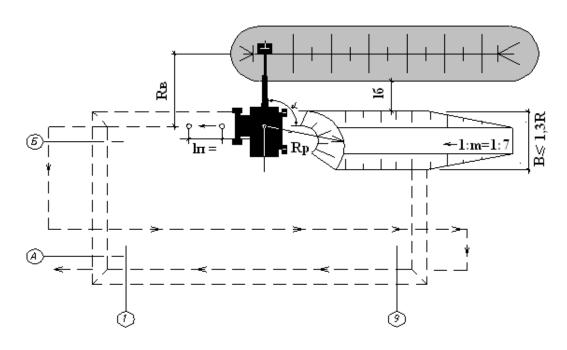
Схема лобовой проходки при устройстве котлованов с разработкой грунта навымет
